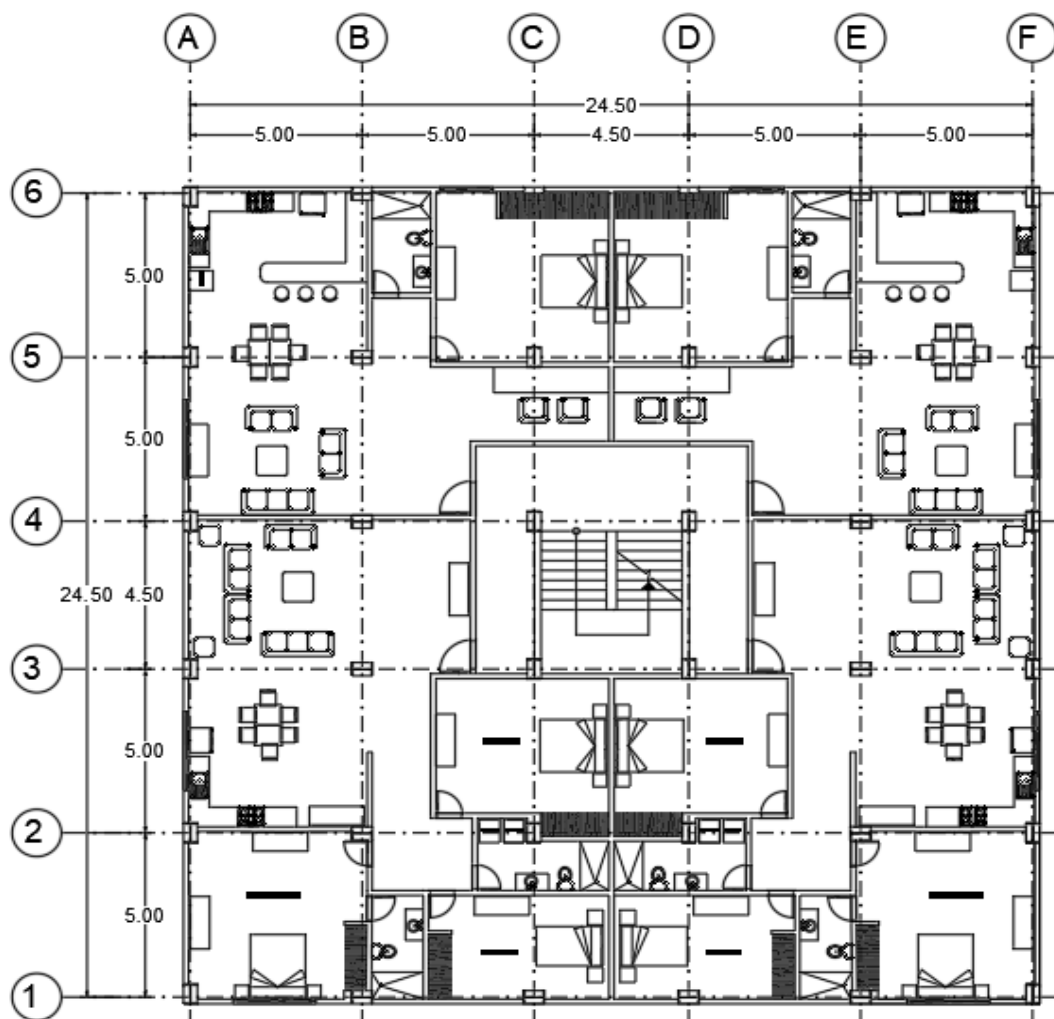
Distribución de la planta arquitectónica en los edificios
